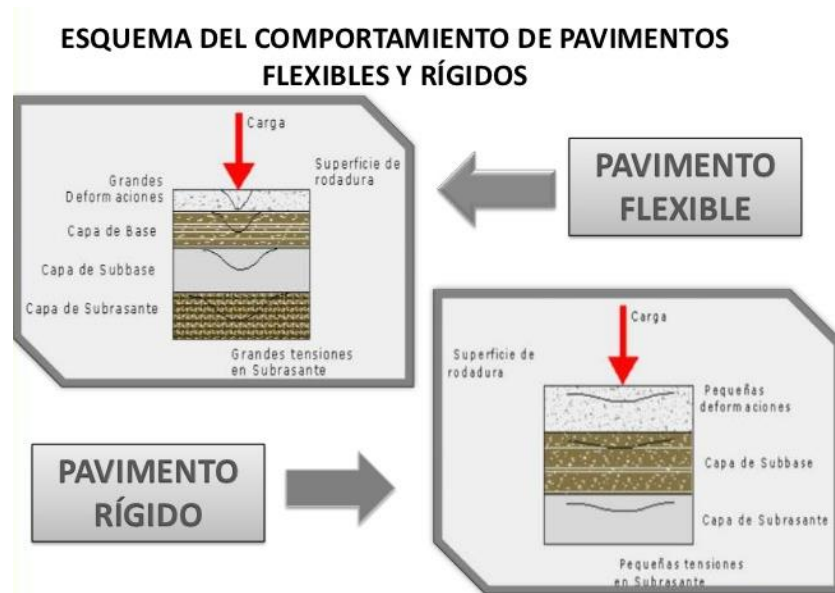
Esquema de comportamiento pavimento flexible y rígido.
